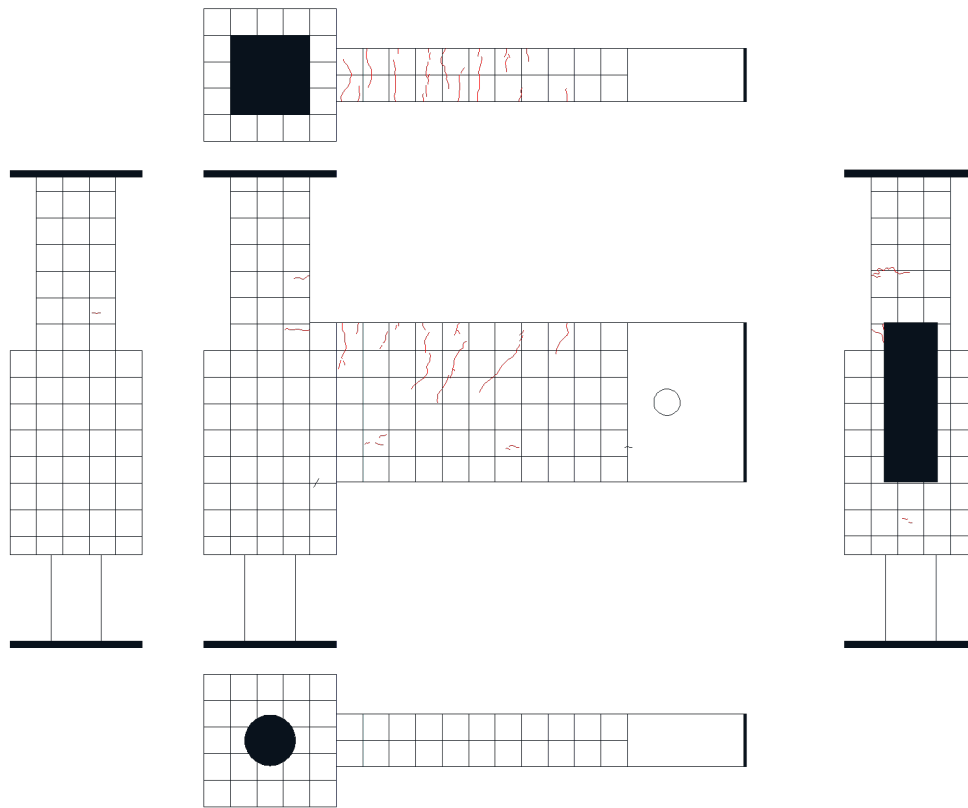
試験体 D-2 ひび割れ状況 (1Cycle)
